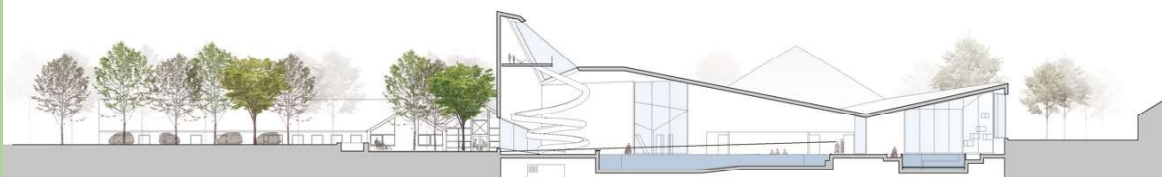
Corte Arquitectónico Proyecto Centro de rehabilitación Vandhalla. CUBO ARKITEKTER, FORCE4 ARCHITECTS
